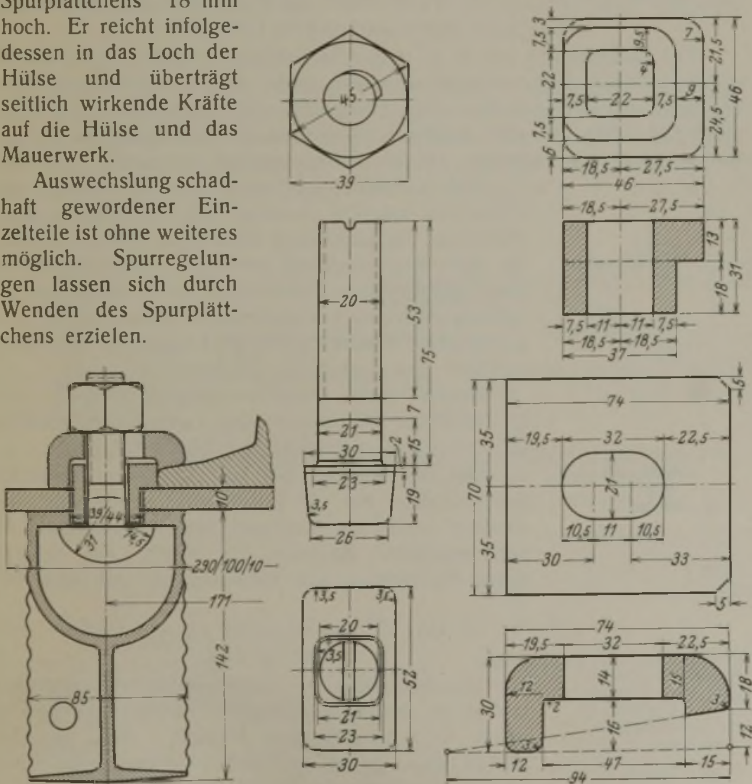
Schienenbefestigung mit Hakenschraubenhülsen.
